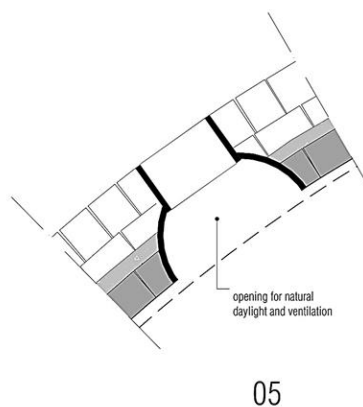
DETALLE CONSTRUCTIVO TRONERA DE CUBIERTA
